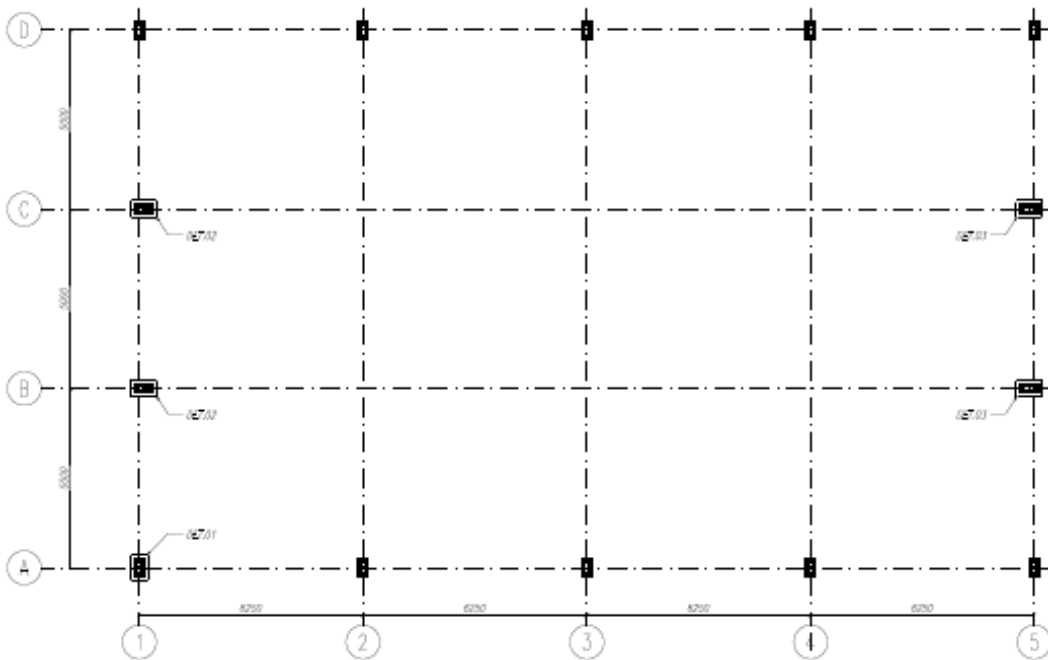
Planta base da nave industrial no AutoCAD 2019
